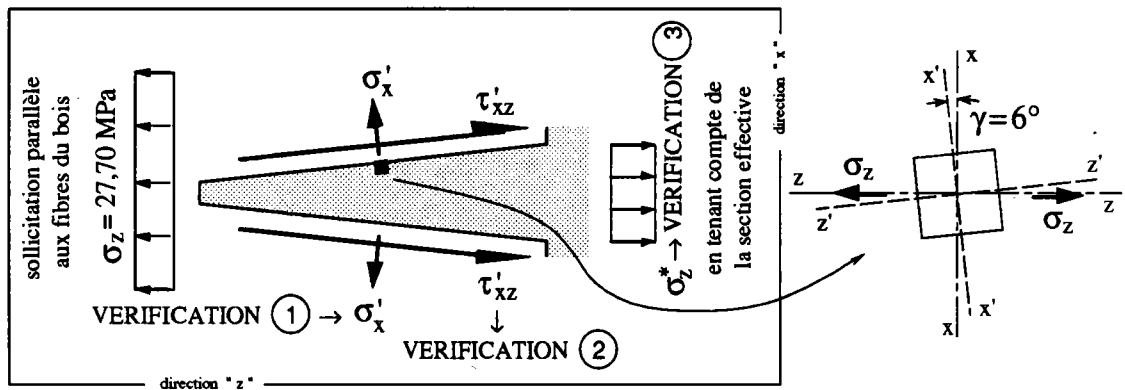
Section suivant un plan parallèle aux fibres du bois de la pièce de coin en contenant la section longitudinale des entures.
